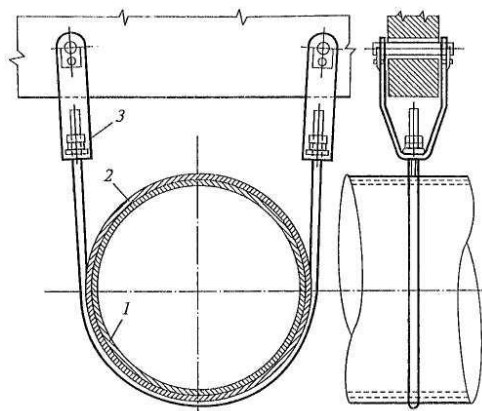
Подвеска газопровода под железобетонным мостом:
